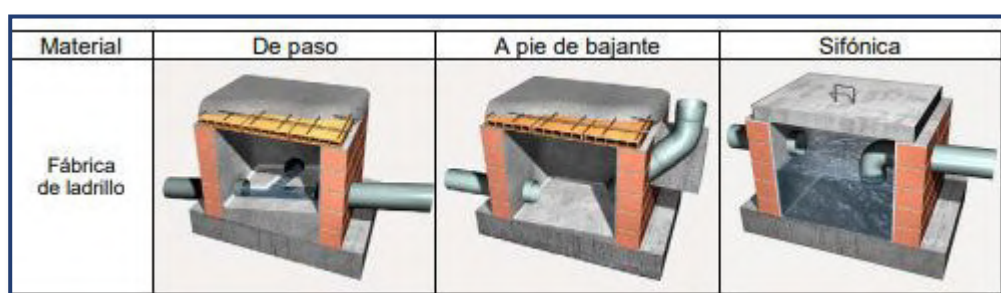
Tipos de arqueta consideradas en este proyecto.
